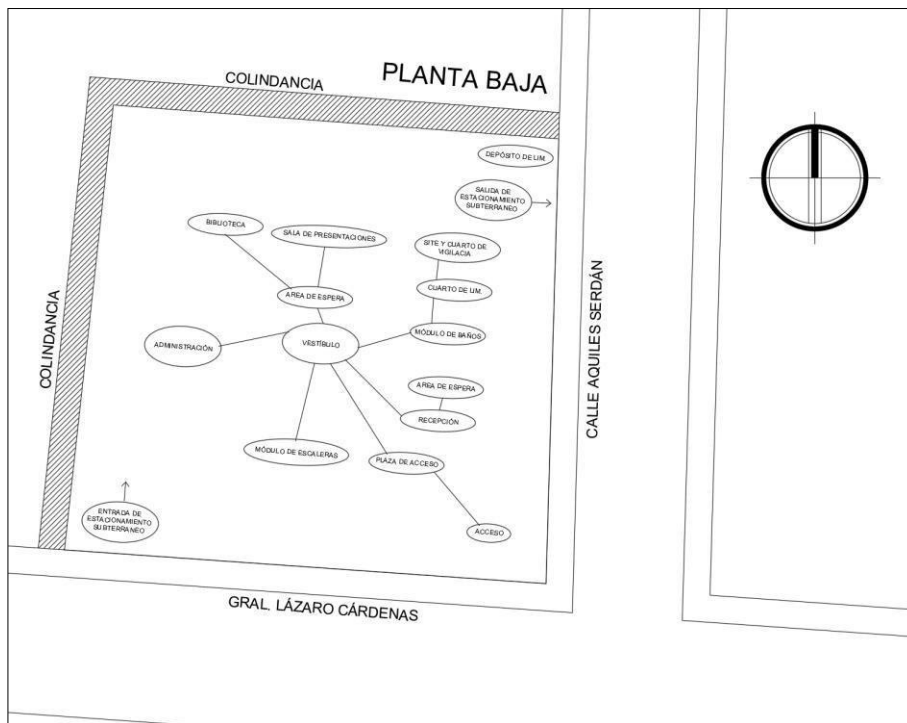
Segunda Propuesta, Planta Baja. Propia 2021.
